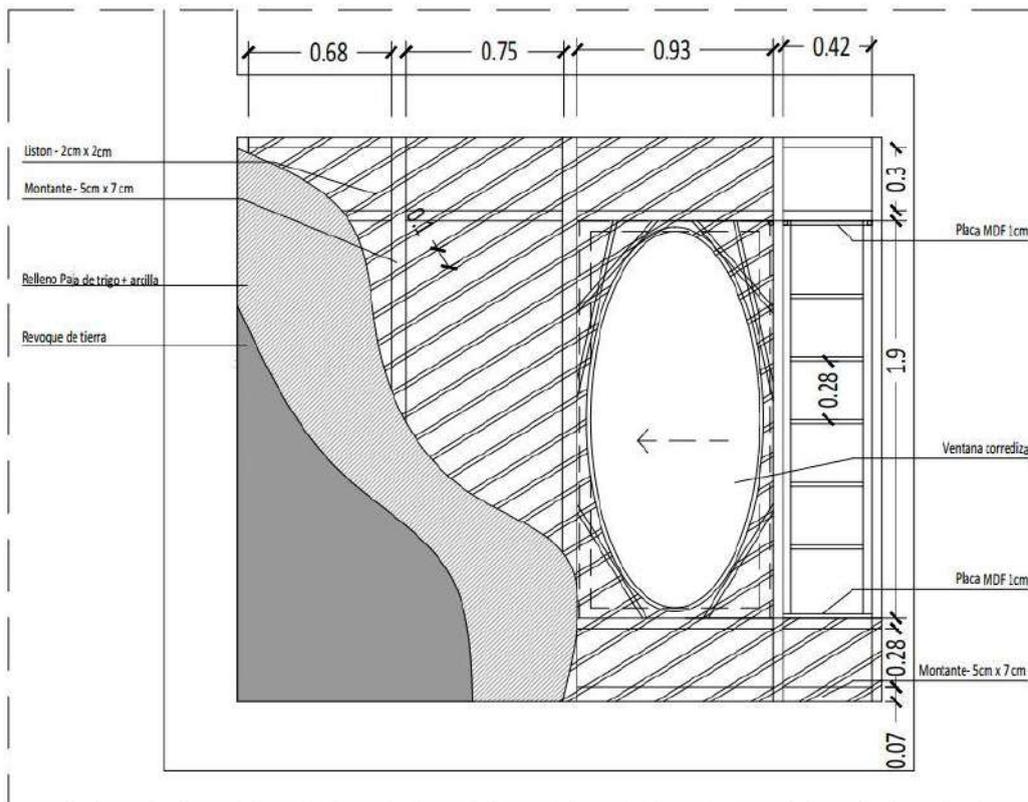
Detalle constructivo de pared con ventana corrediza.
